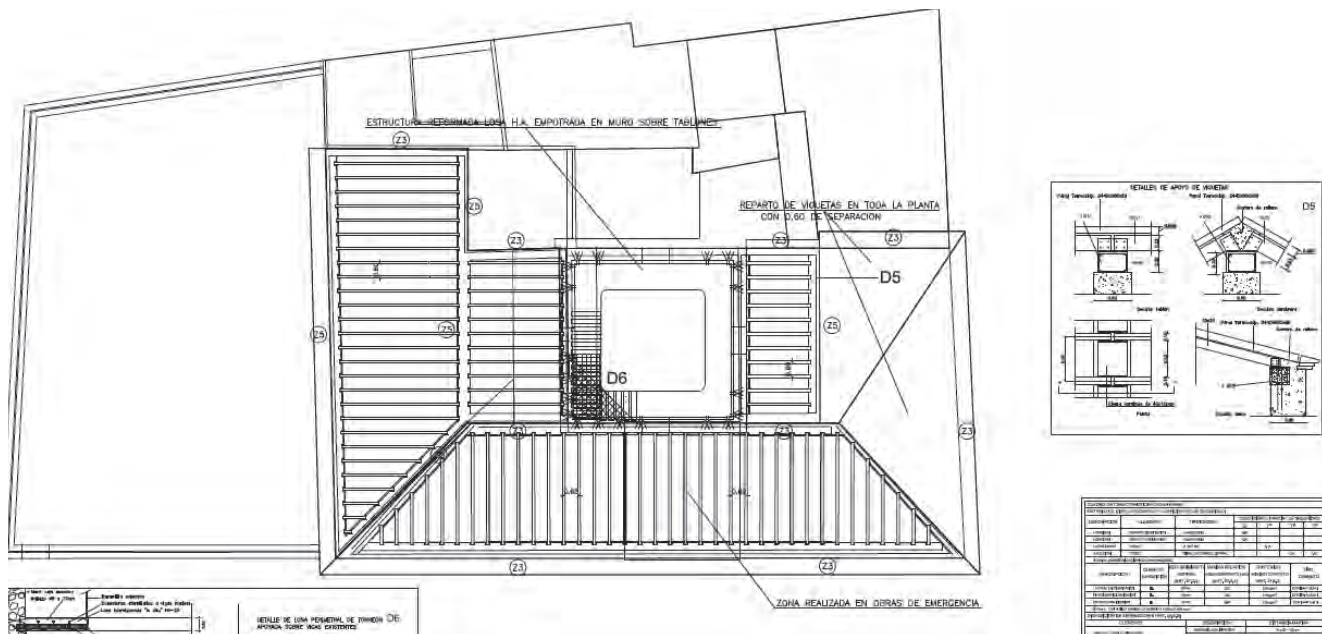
Planta cubierta y torreón. Reparación de estructura.
